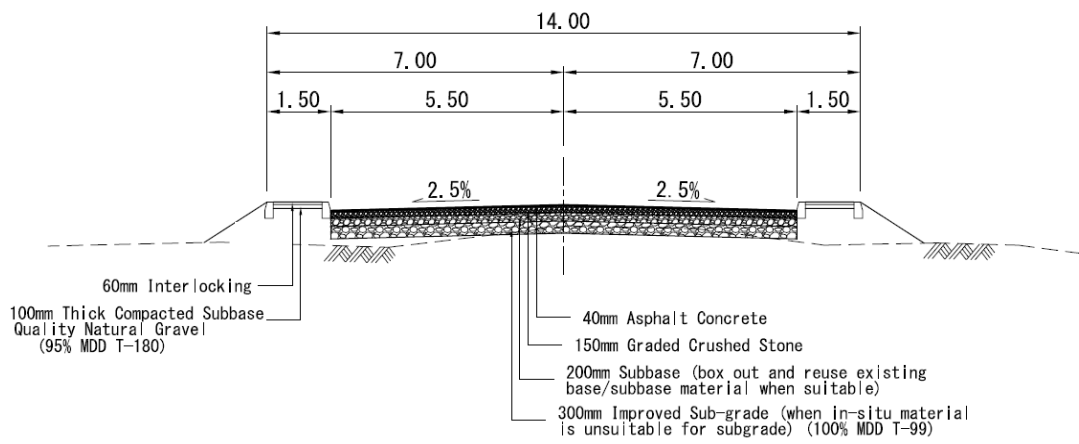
道路標準断面図 (計画) Road J3 (橋梁 No.10)
